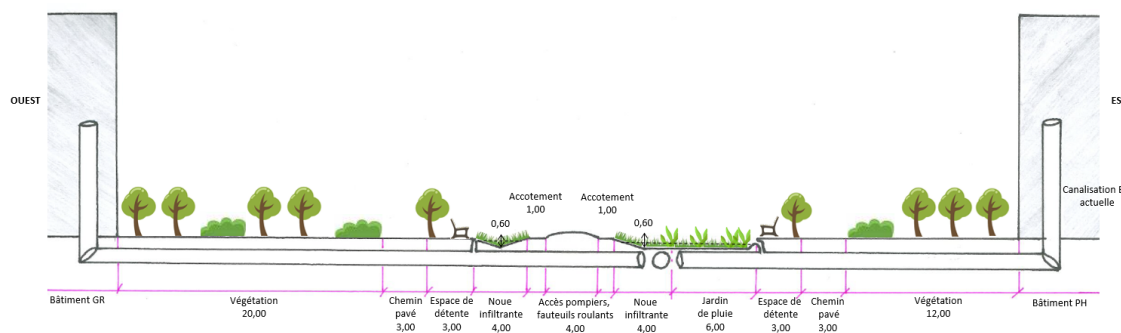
Plan de façade à façade pour le scénario 1 au niveau de la coupe 1.
